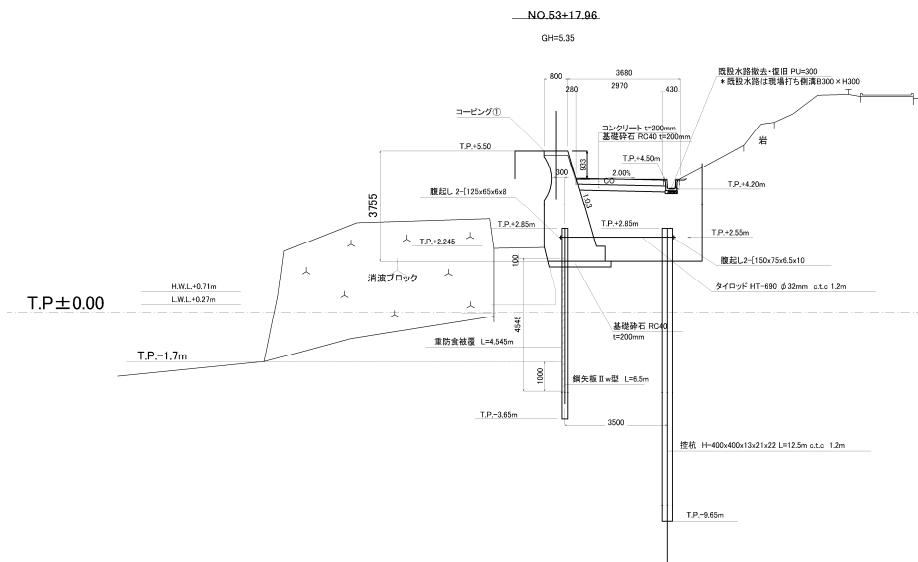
施工事例 控え鋼矢板 標準断面図 (新潟海岸・金衛町)
